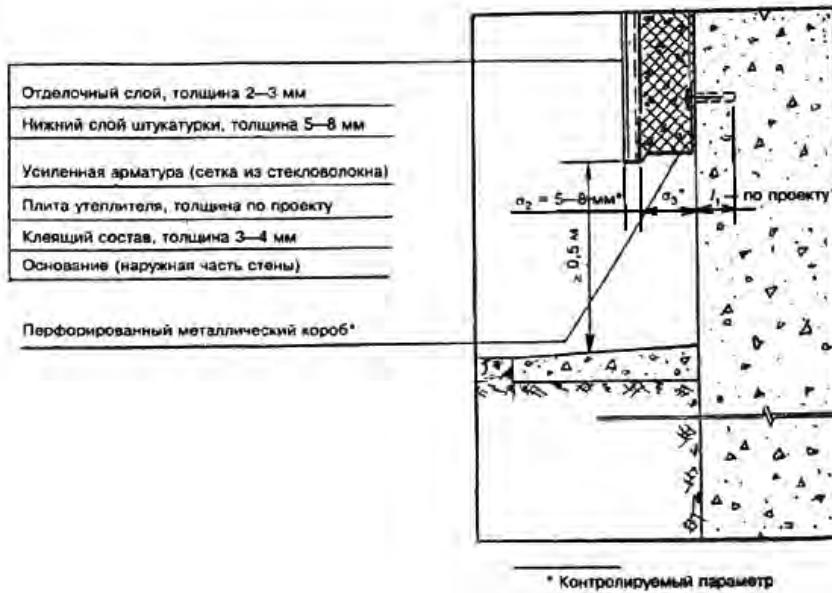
Крепление теплоизоляционного слоя на нижней части стены
